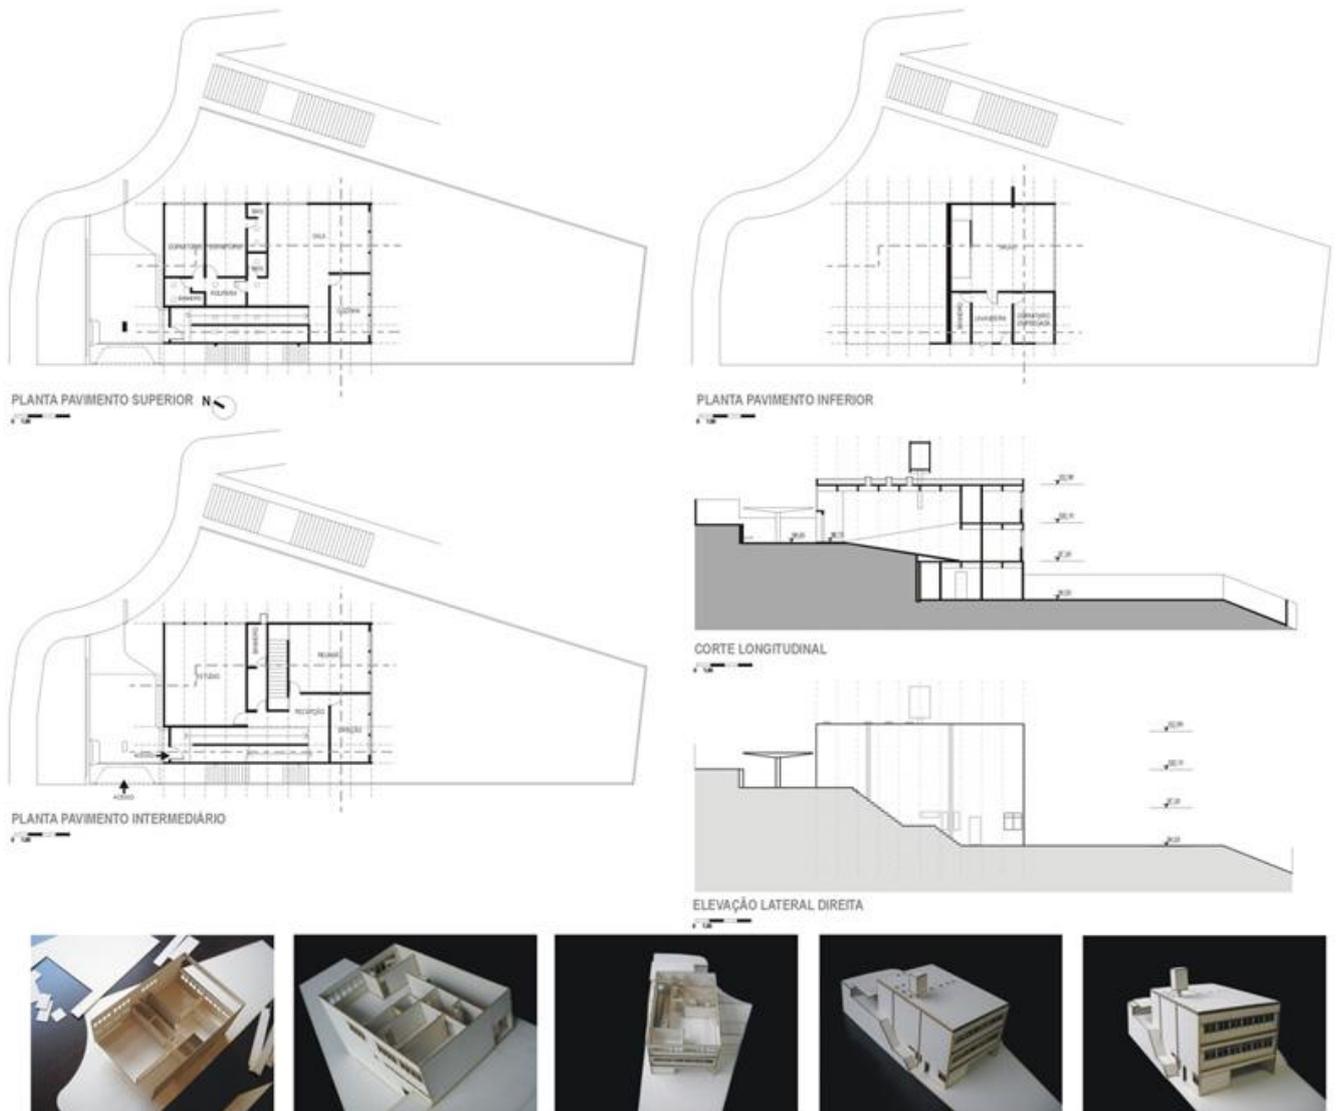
Plantas, corte e elevação projeto para residência Waldemar Cordeiro (1971).
